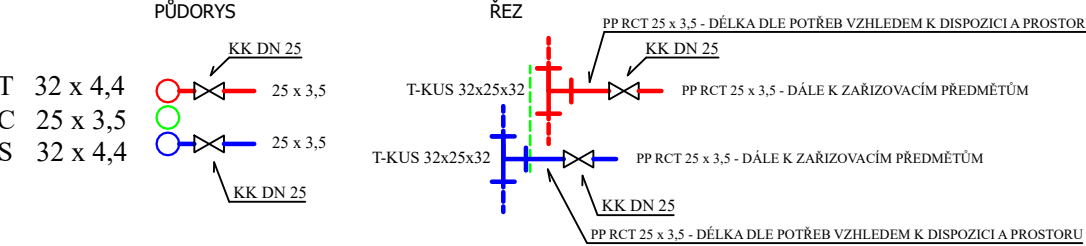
NAPOJENÍ PŘIPOJOVACÍHO POTRUBÍ
